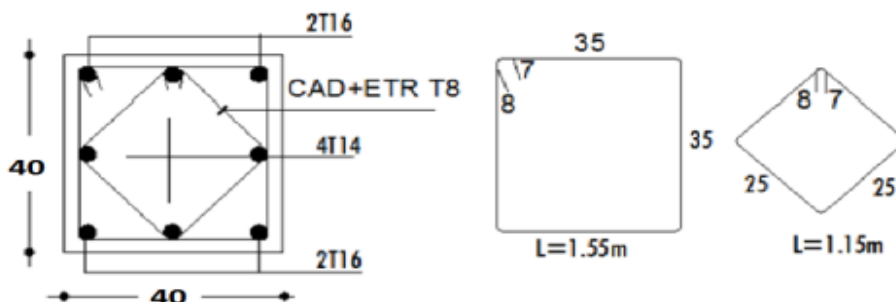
Coupe du ferrailage des poteaux 40x40
